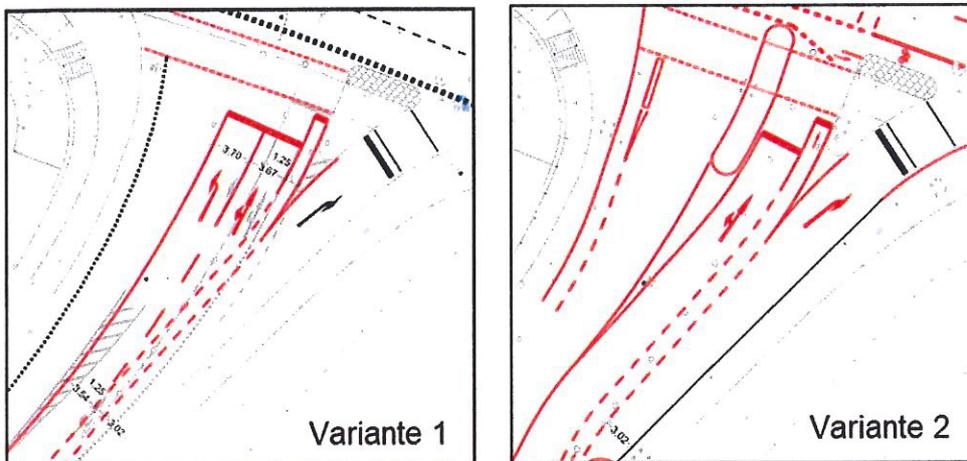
KP Gabelsberger Str./ Lahnstr., bestehende Planung Stadt Gießen
